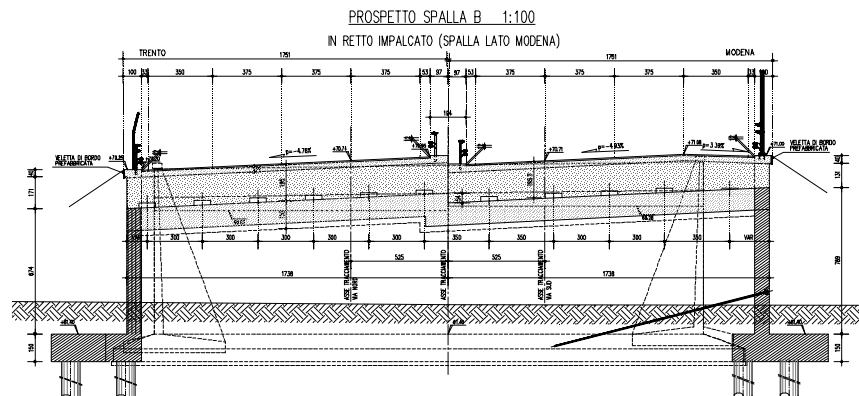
Spalle – Prospetto in retto impalcato
